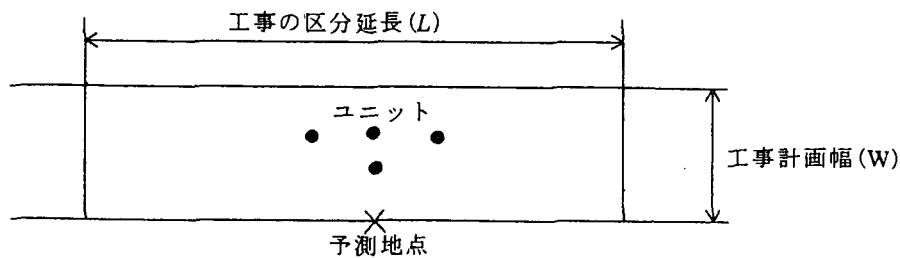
施工範囲が特定される場合の施工範囲とユニットの配置例
